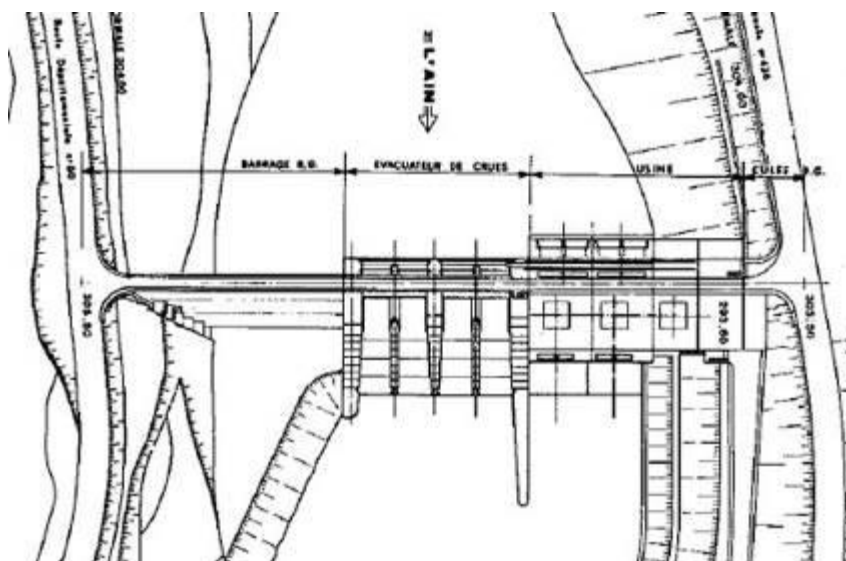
Vue en plan des ouvrages de l'aménagement de Coiselet
